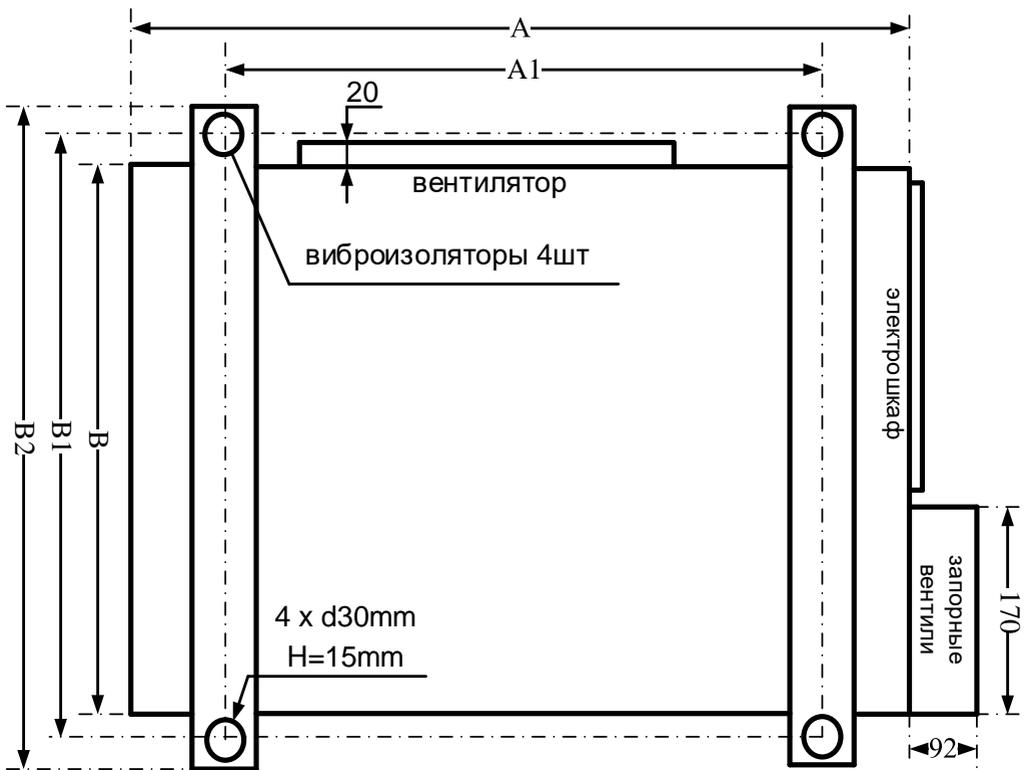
Схема габаритных размеров и крепления виброизоляторов к ККБ (вид снизу)
